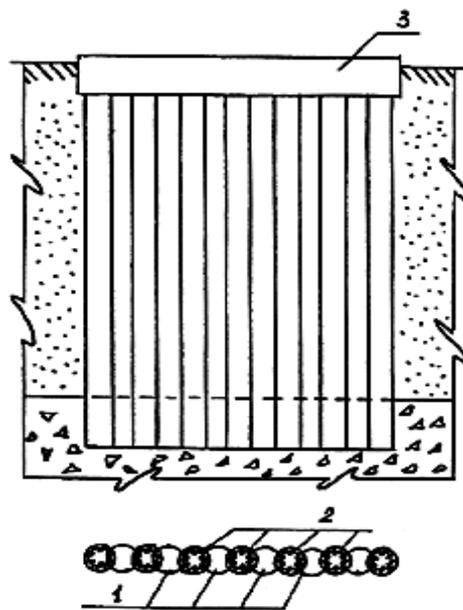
Схема фундамента из буросекущихся свай:
